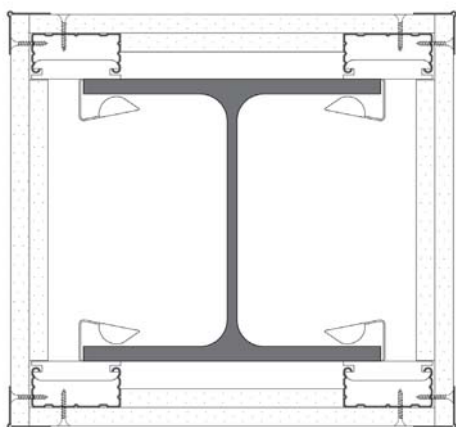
Protection poteau simple peau avec bandes de plâtre
